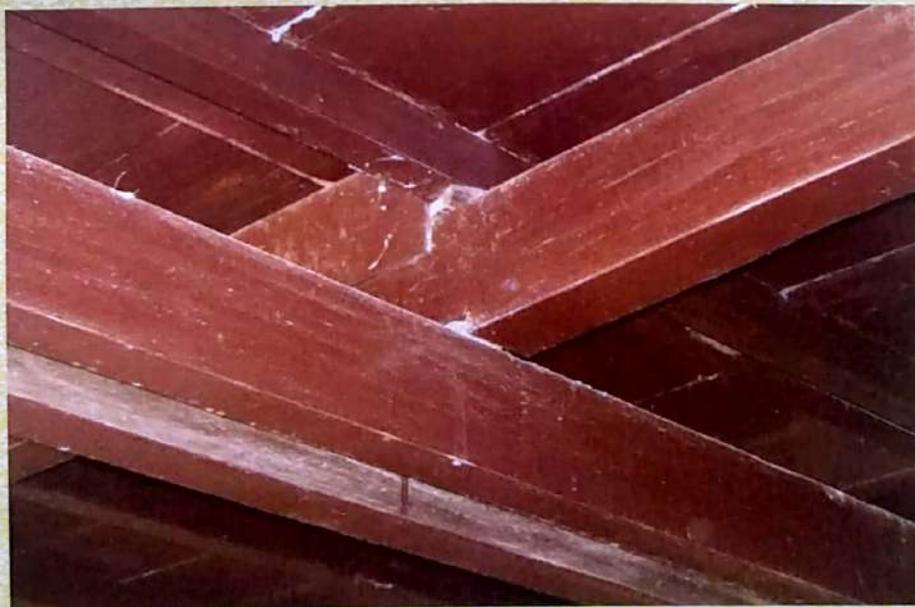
Balok yang menjadi *pallangga caddi* dan *pallangga lompo
